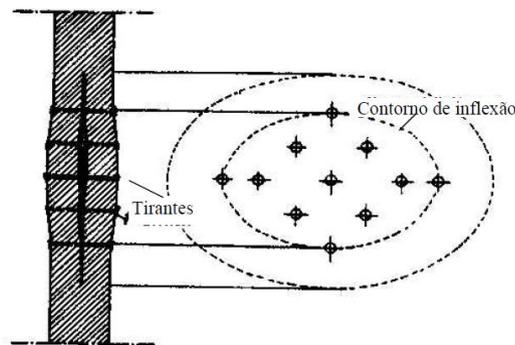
Distribuição correta das pregagens transversais face à secção da parede de alvenaria [39]
